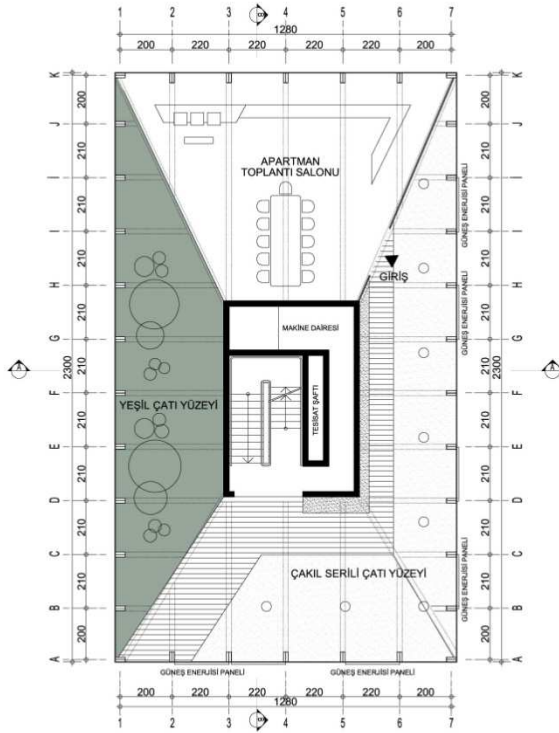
Çatı sarnıcı pilot bölge vaziyet planı (Alsancak).
